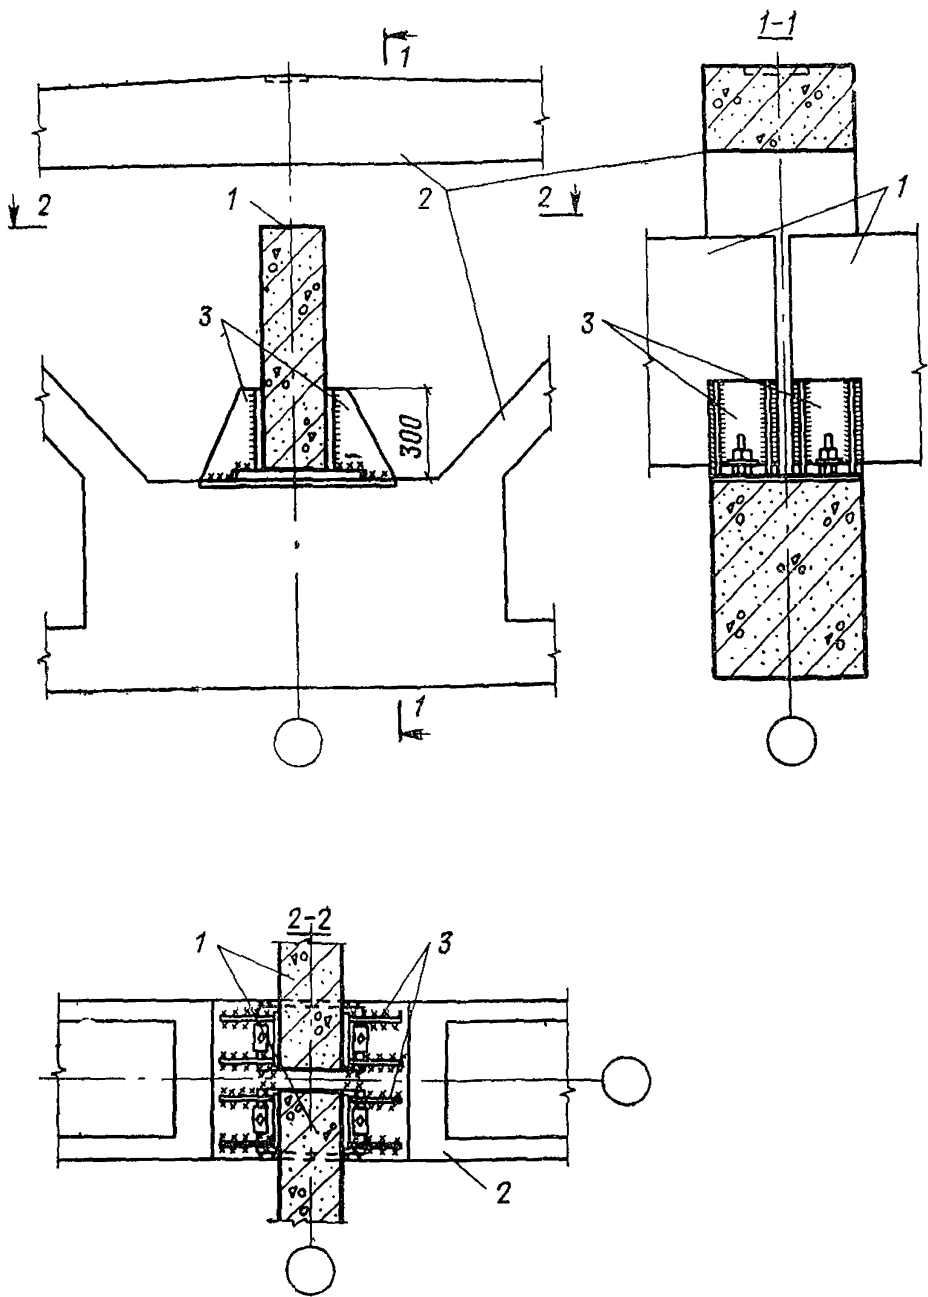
Крепление стропильных ферм к подстропильной в середине ее пролета (при скатной кровле) в зданиях с расчетной сейсмичностью 8 баллов
